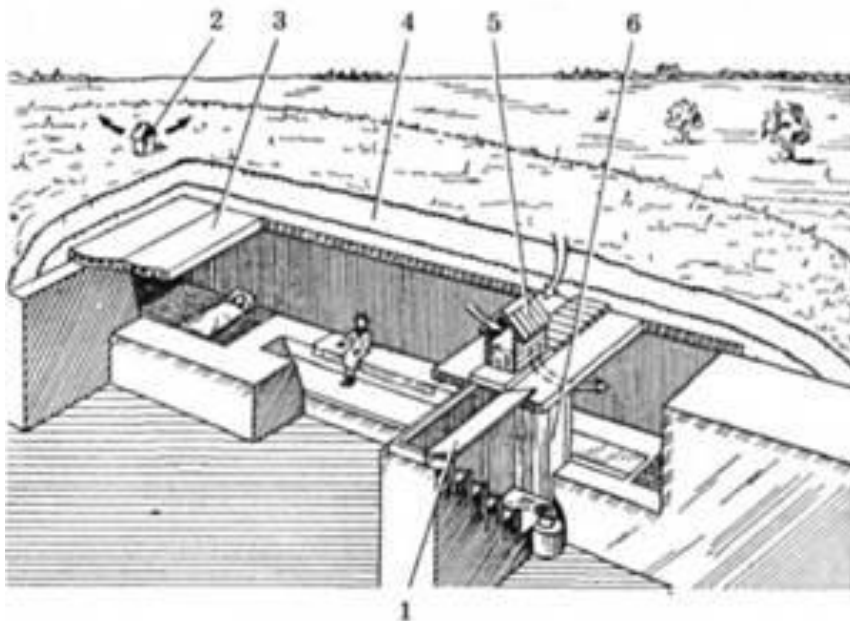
Протирадіаційне укриття з перекриттям із залізобетонних плит:
